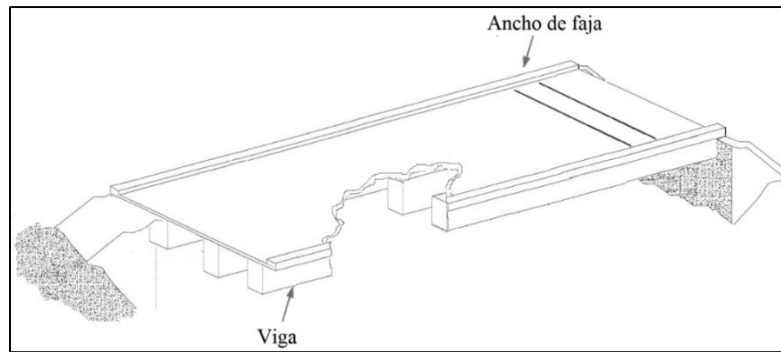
Ancho de Franja en losa con acero de refuerzo perpendicular al tránsito.
